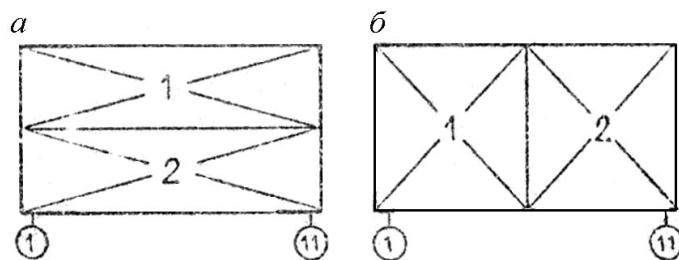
Схемы разбивки здания на хватки вдоль (а) и поперек (б) пролетов
